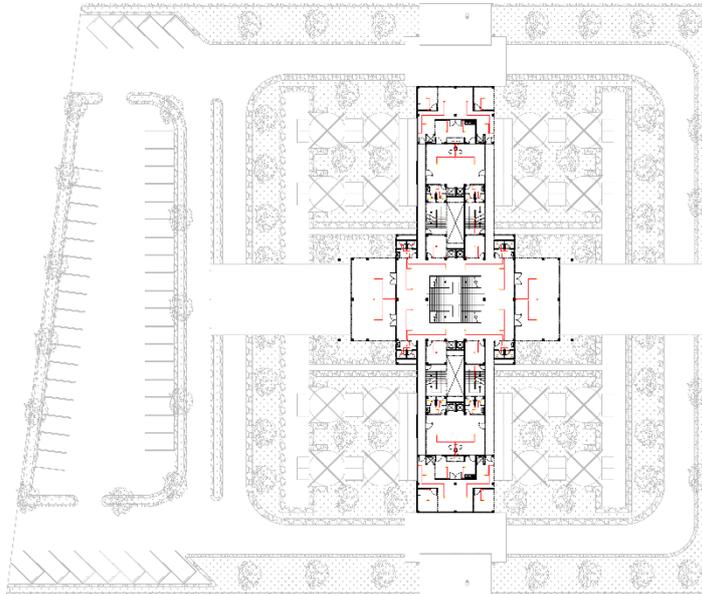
Instalasi Listrik Lantai 1 (Penulis, 2018)
